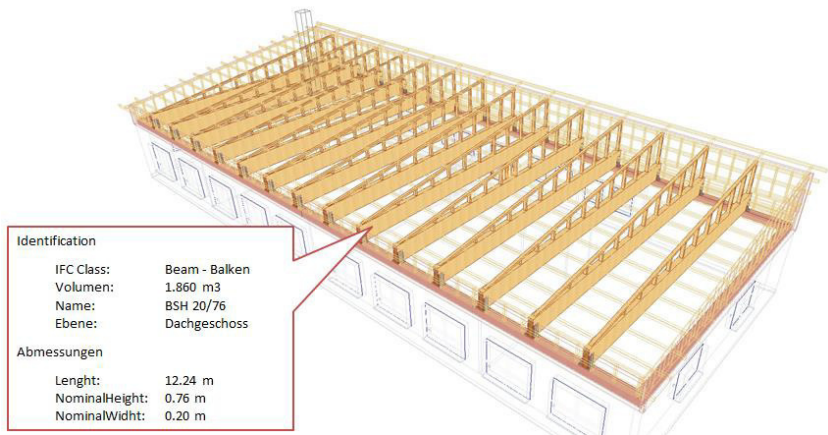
IFC-Modell einer Dachkonstruktion mit Holzbindern
